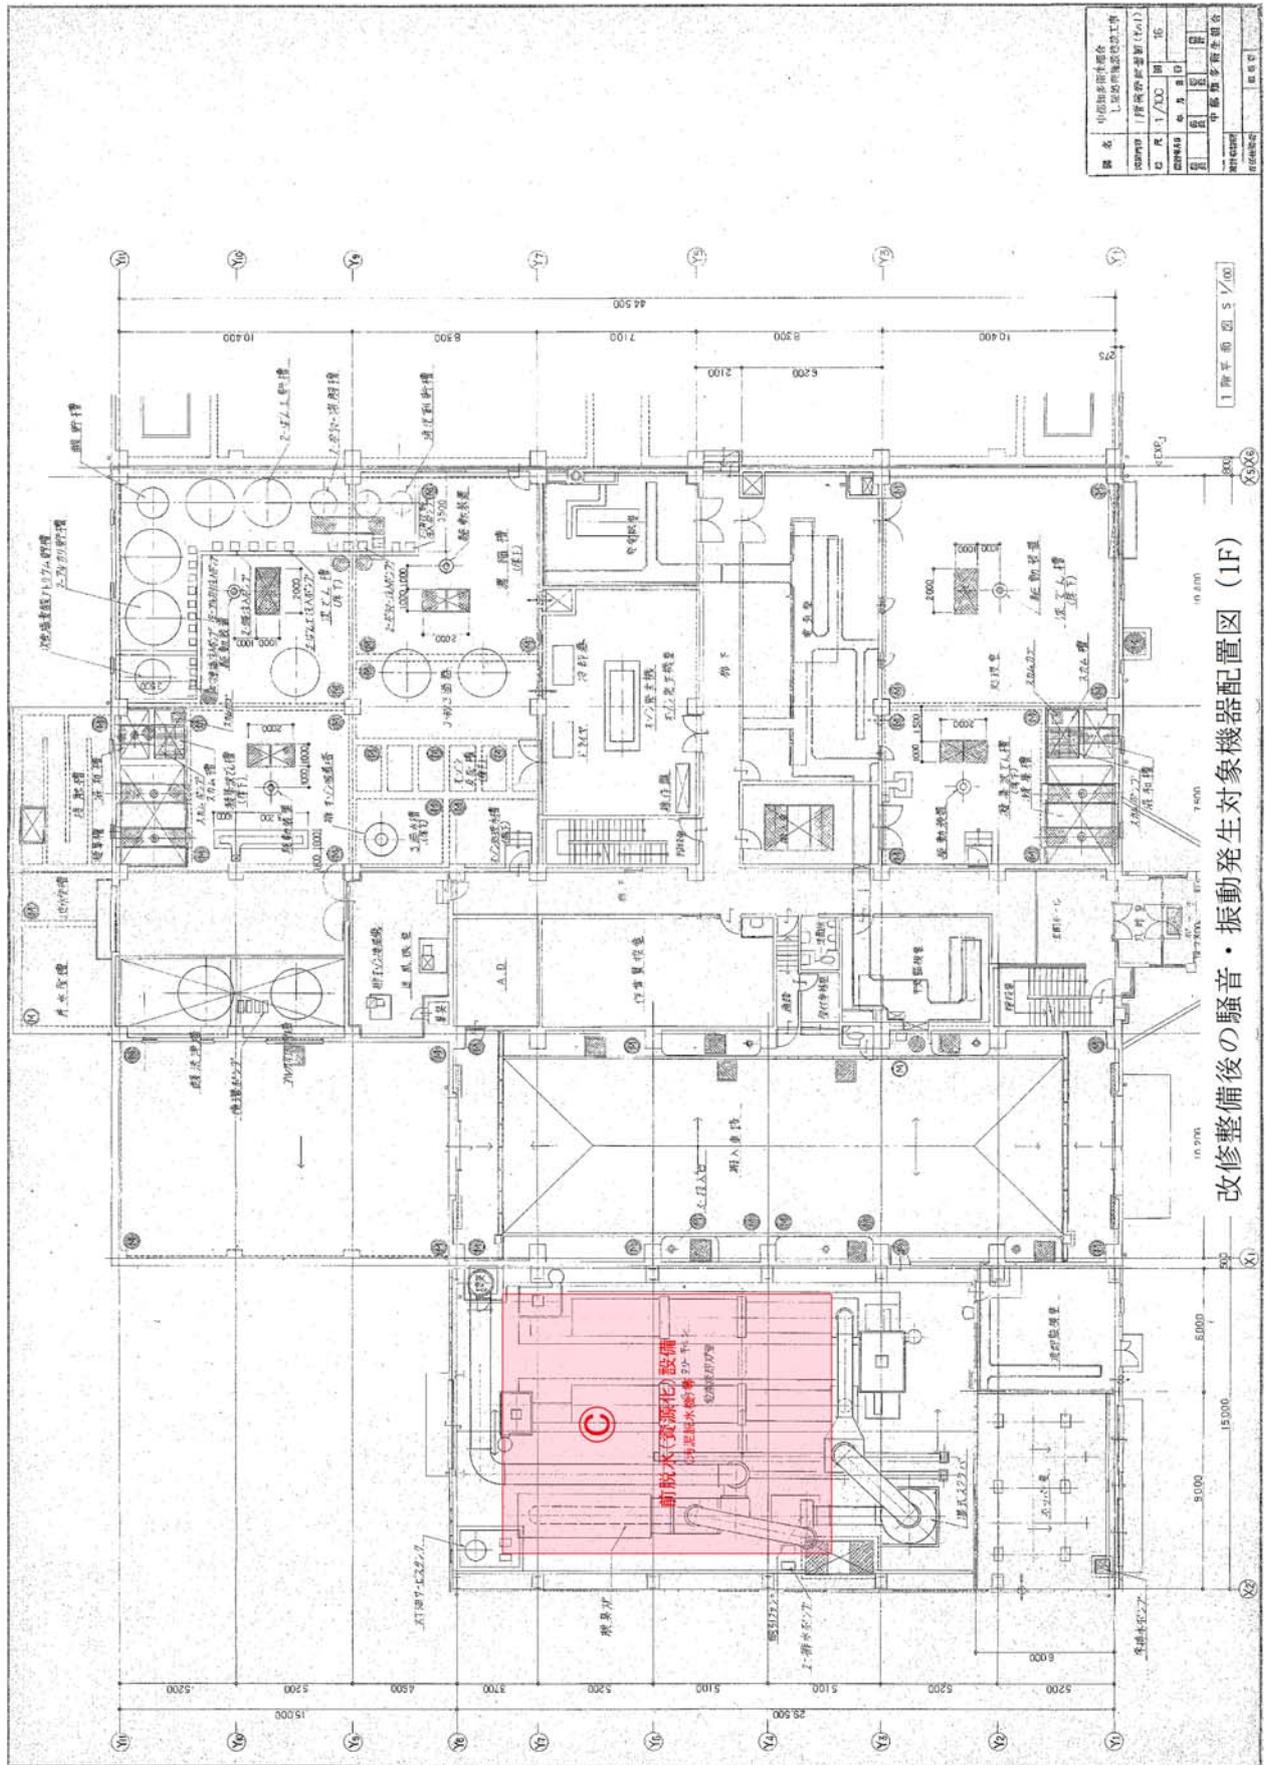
(2) 改修整備後機器配置図 (2/3)
